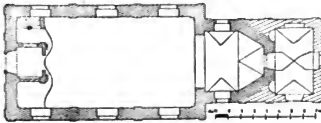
Byszitz. Grundriss der Kirche.
